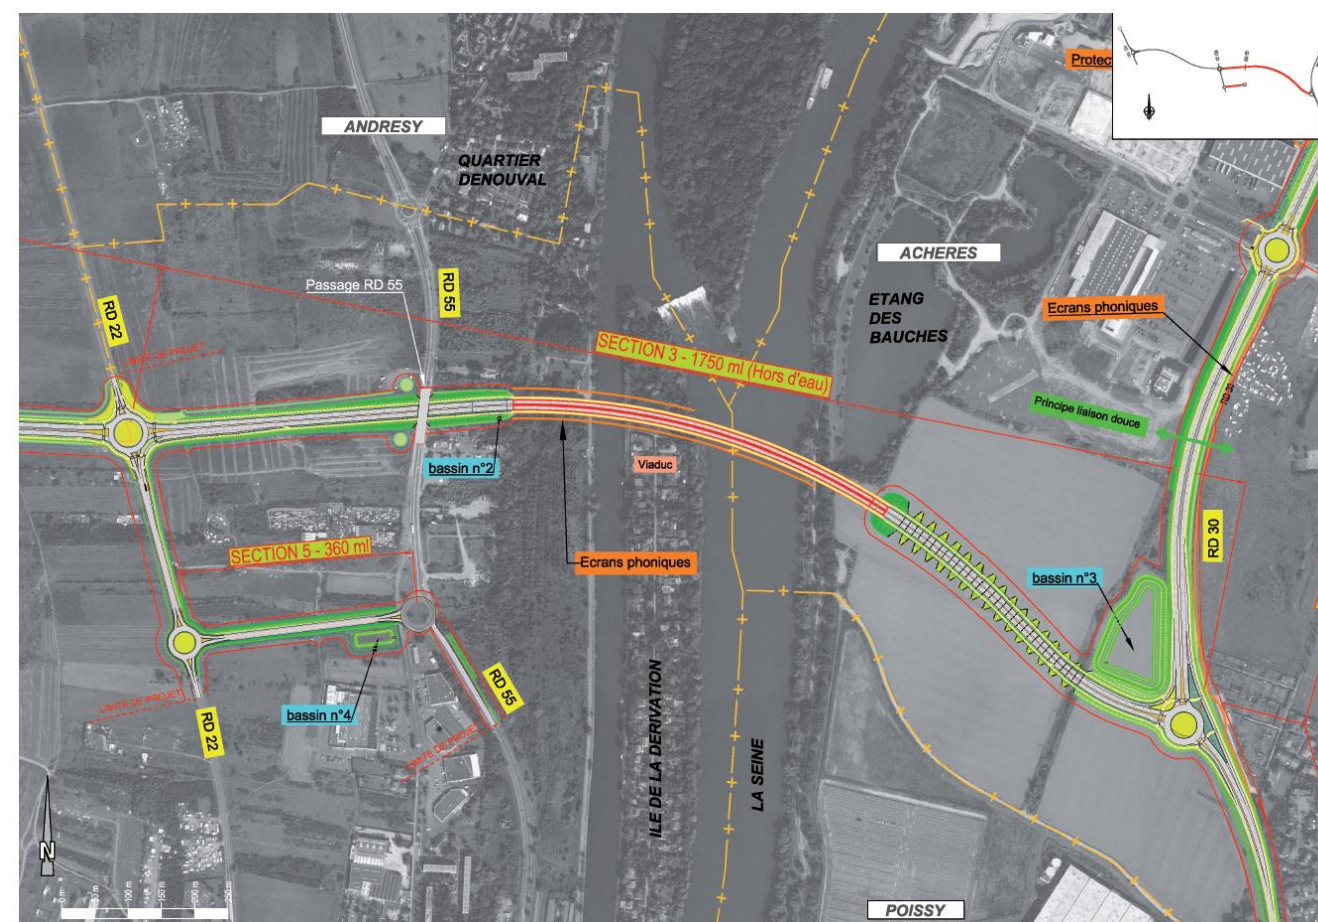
Plan Général des Travaux de la liaison RD30 – RD190
